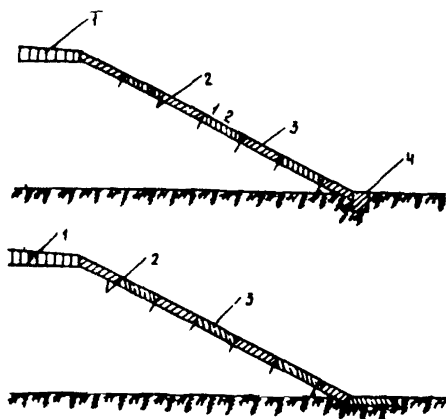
Схемы укрепления откосов насыпи решетчатыми конструкциями со специальным упором (а) и без него (б): 1-защитный слой на обочине; 2-штыри металлические; 3-решетка из сборных элементов; 4-упор бетонный
